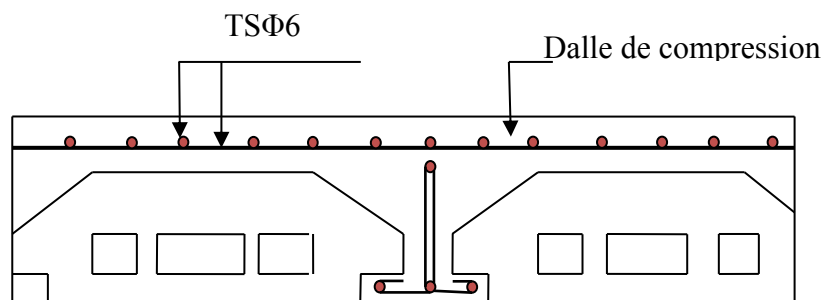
Schéma de ferraillage de la dalle de compression.
